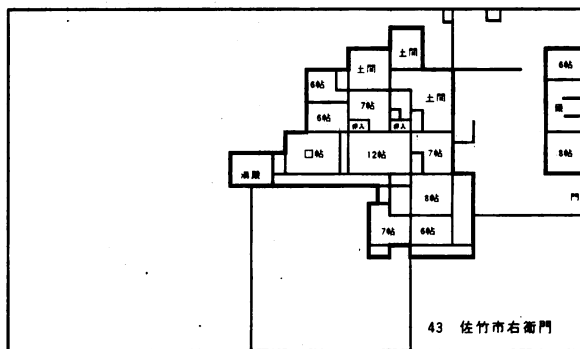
享保6年所司代下屋敷絵図の大型住宅平面図
